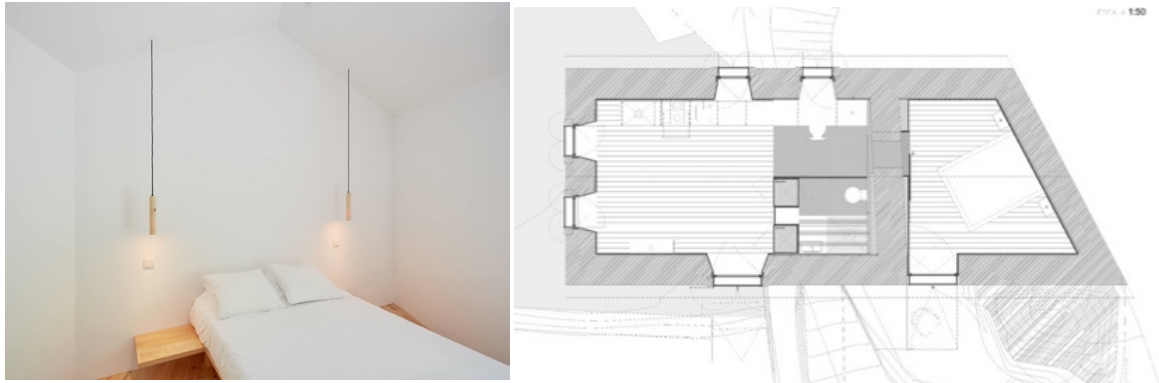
Fotografias do interior e planta - Moinho das Fragas.
